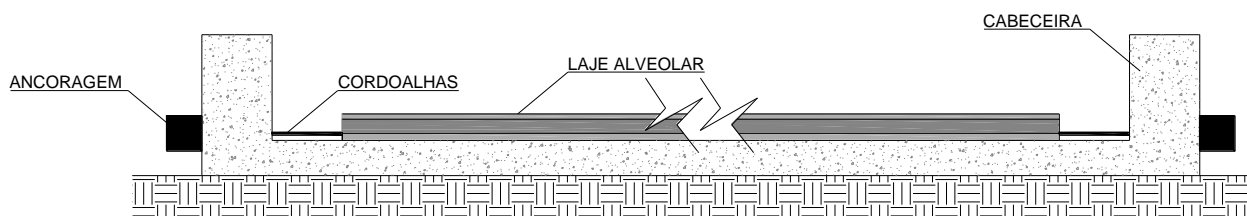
5 – Elemento disposto na pista de protensão (sistema de pré-tração).
